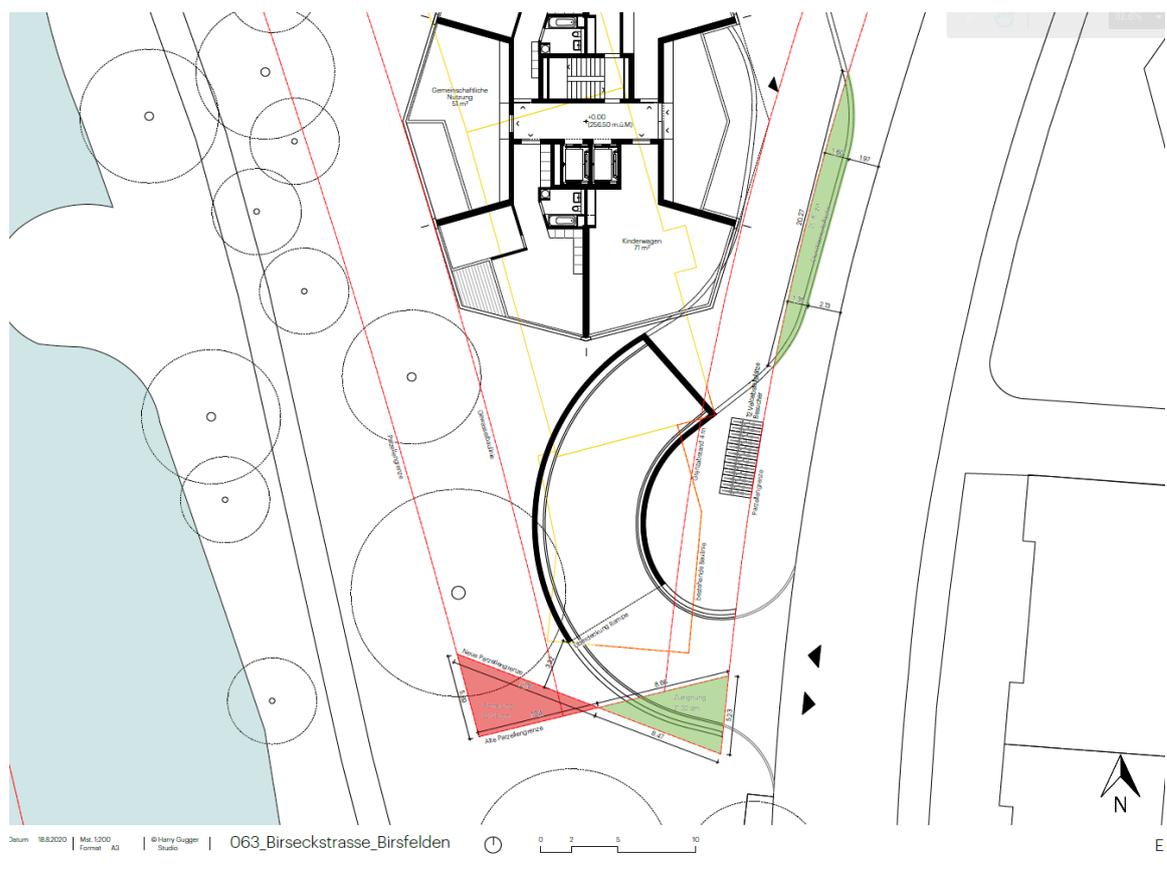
Planausschnitt Erdgeschoss Baubereich C und Rampe anschliessendem Durchfahrtsbereich
